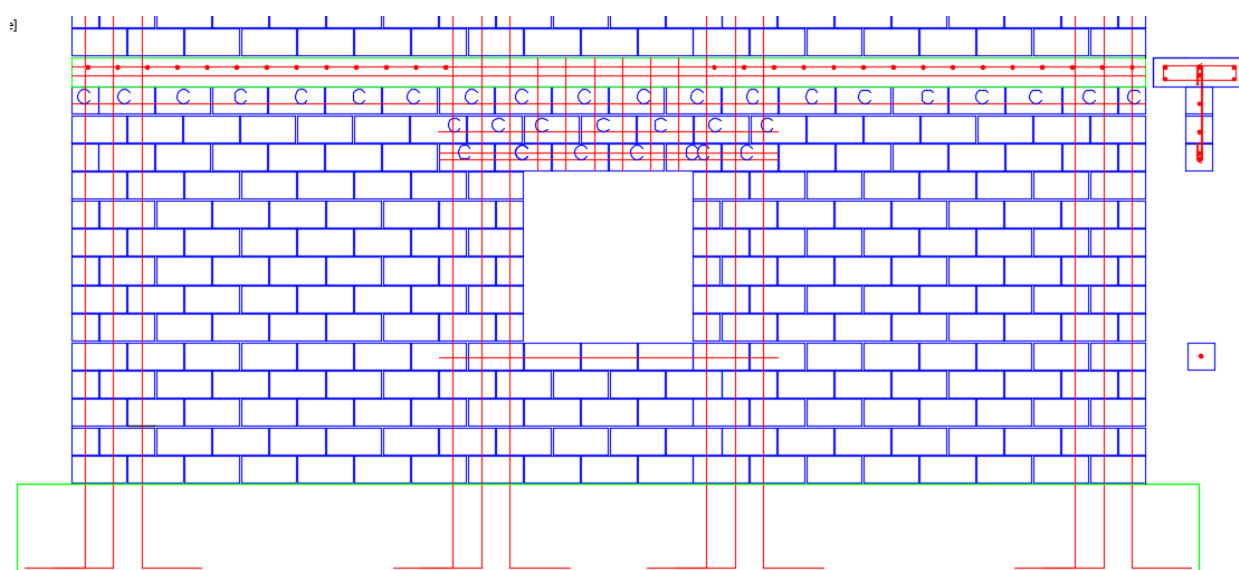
Detalhe dos linteis de alvenaria armada sobre as aberturas de janela
